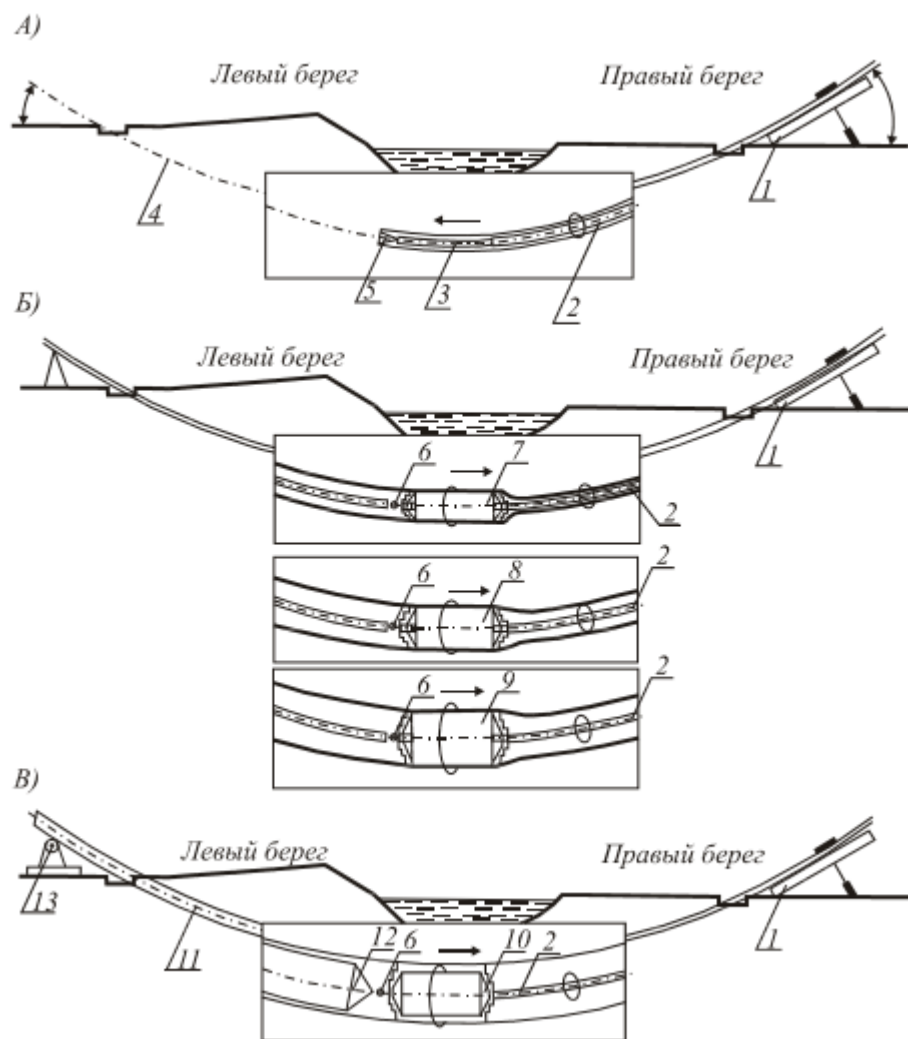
Схема прокладки трубопровода методом ННБ:
